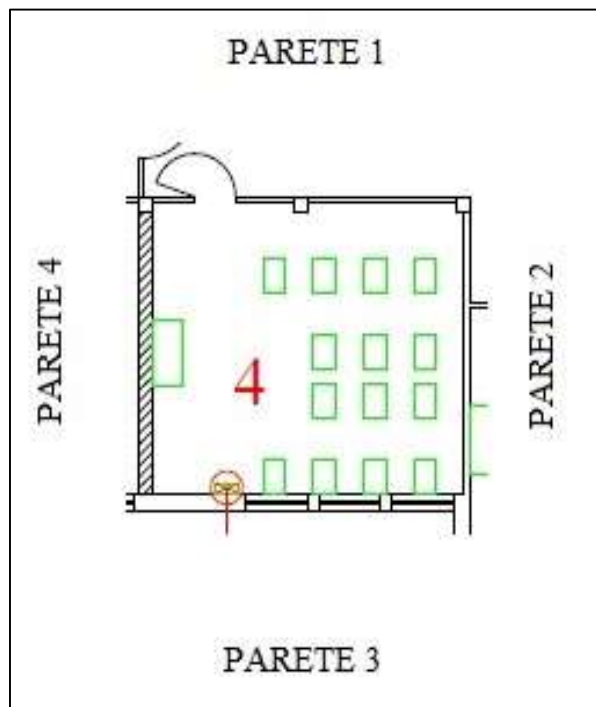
Planimetria dell'Aula 4 (2°A) oggetto di misurazioni
